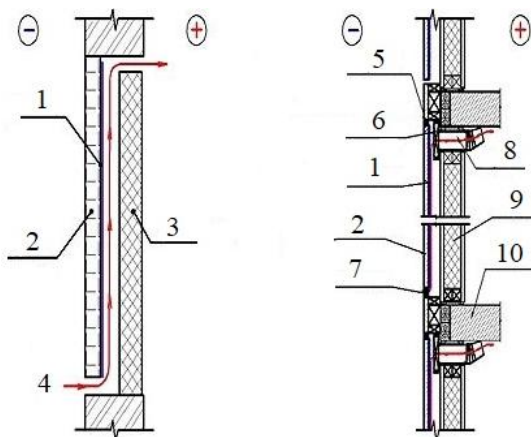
Варианты решения навесных вентилируемых фасадов для использования в системе «активного» энергосбережения
